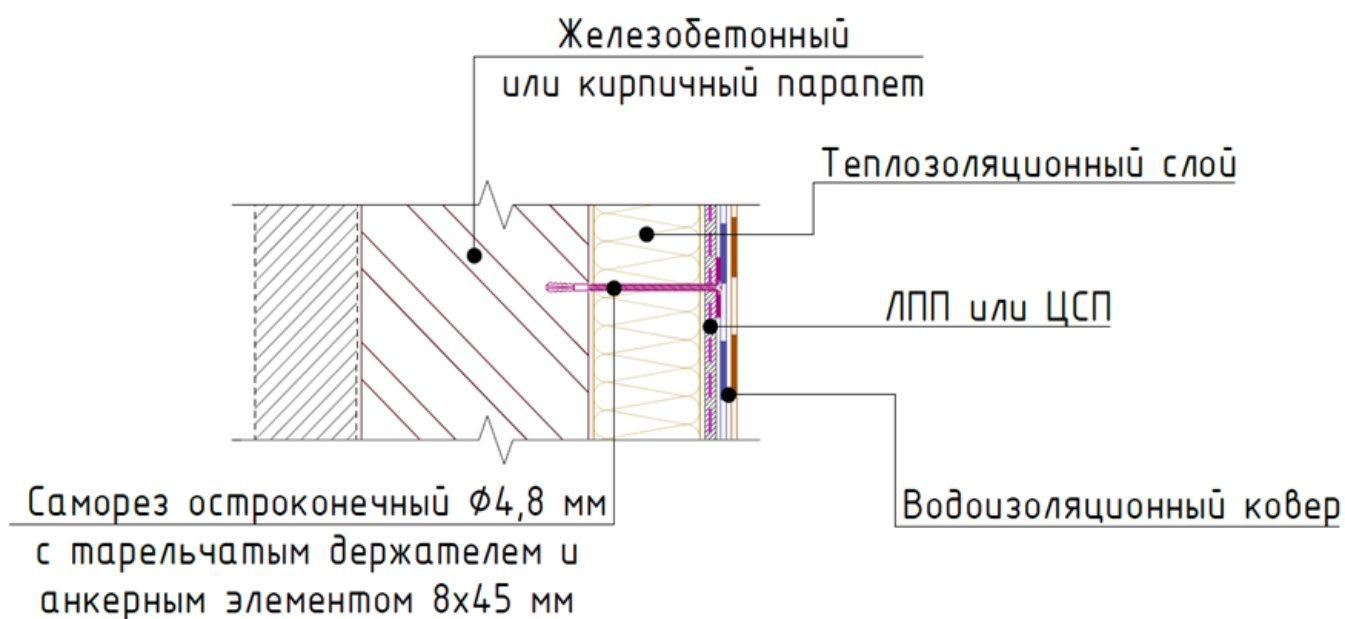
Крепление ЛПП или ЦСП к утепленному железобетонному или кирпичному парапету
